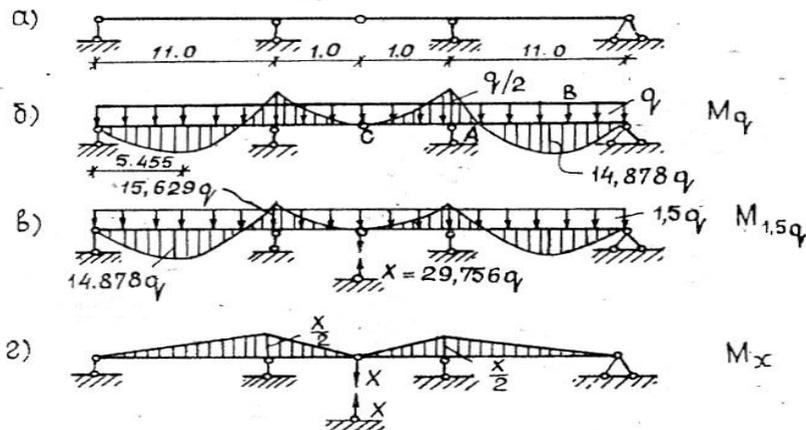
Эпюры, получившиеся при расчёте ригеля рамы перекрытия
